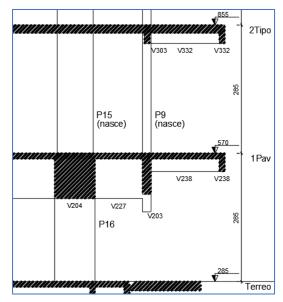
Detalhes do corte – vista dos pilares em transição – Pilares em transição. Fonte: Autores
